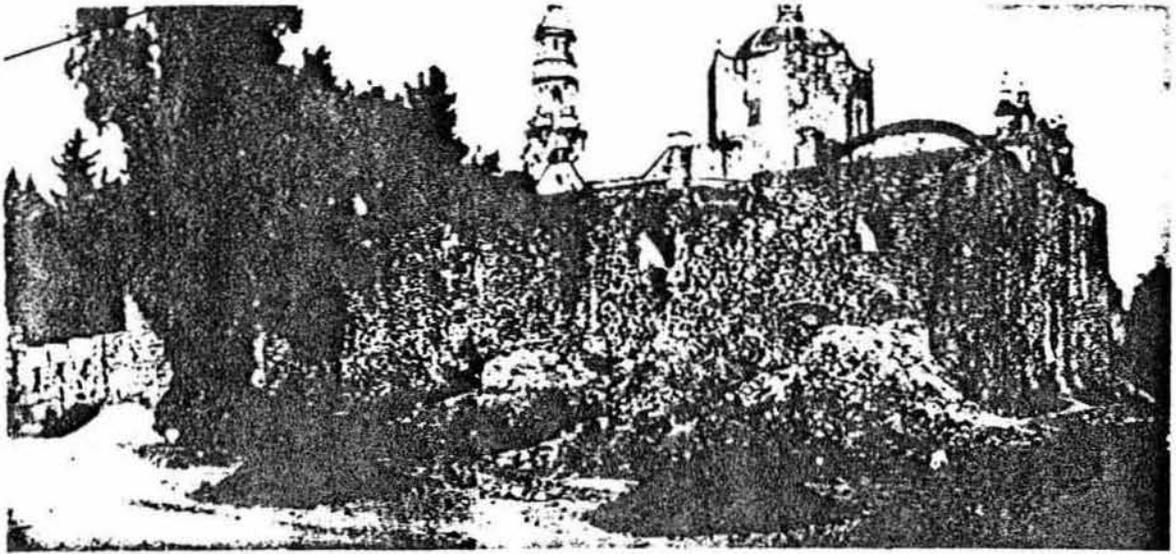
Excavaciones en el lado sur del convento de Oxtotipac
